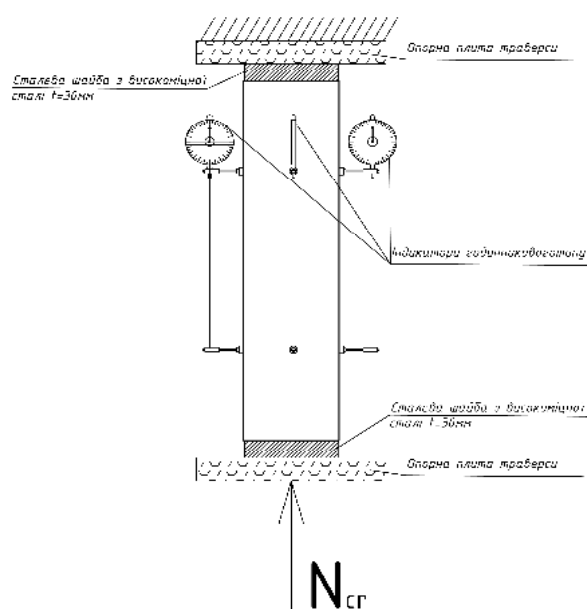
Схема передачі навантаження на бетонне ядро
